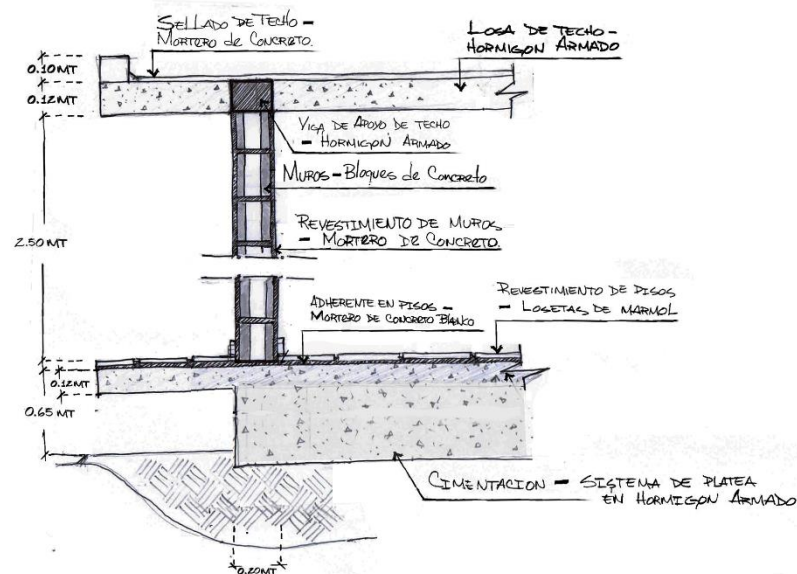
Detalle de sistema de Mampostería. Elaboración Propia
